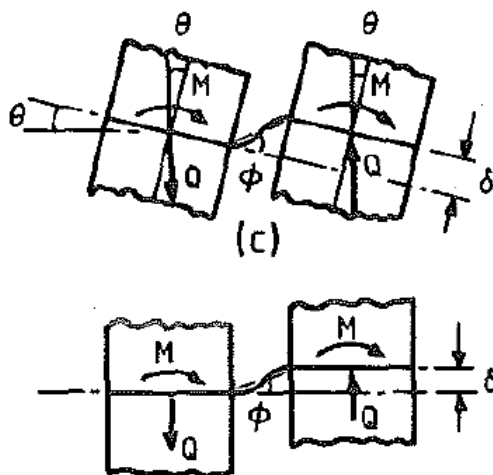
Comportamiento de Sistema de Muros de Corte Acoplados con Losas ante Cargas laterales[8]
